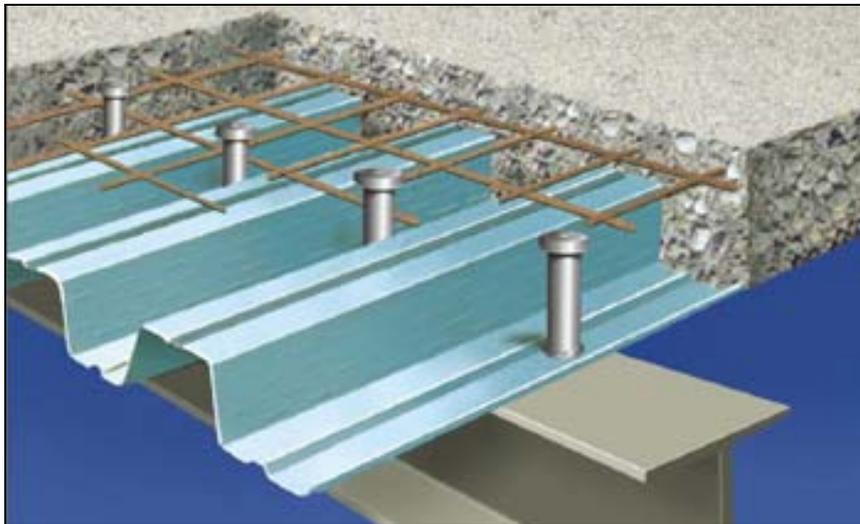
Corte transversal da estrutura utilizada na montagem do *steel deck*.
